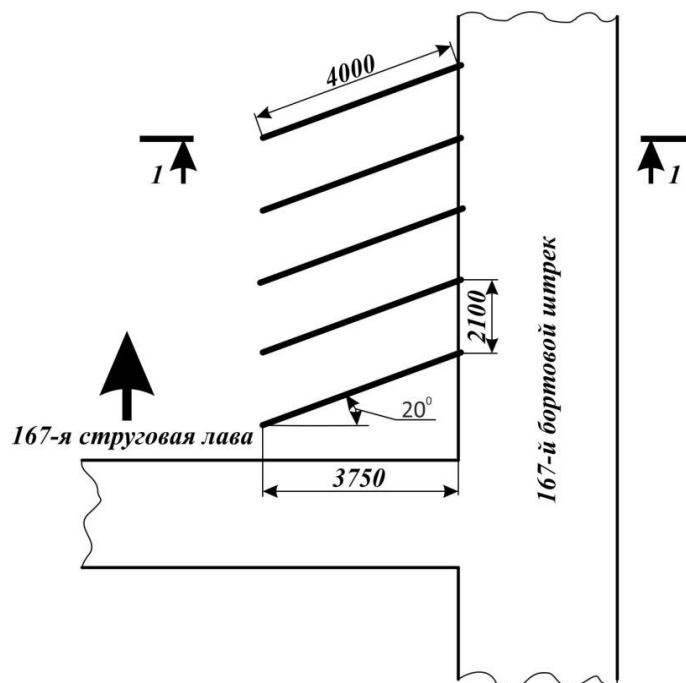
Участок бортового штрека с полным перекрытием анкерной крепи, усиленный проколотами со стороны 167-й струговой лавы в плане
